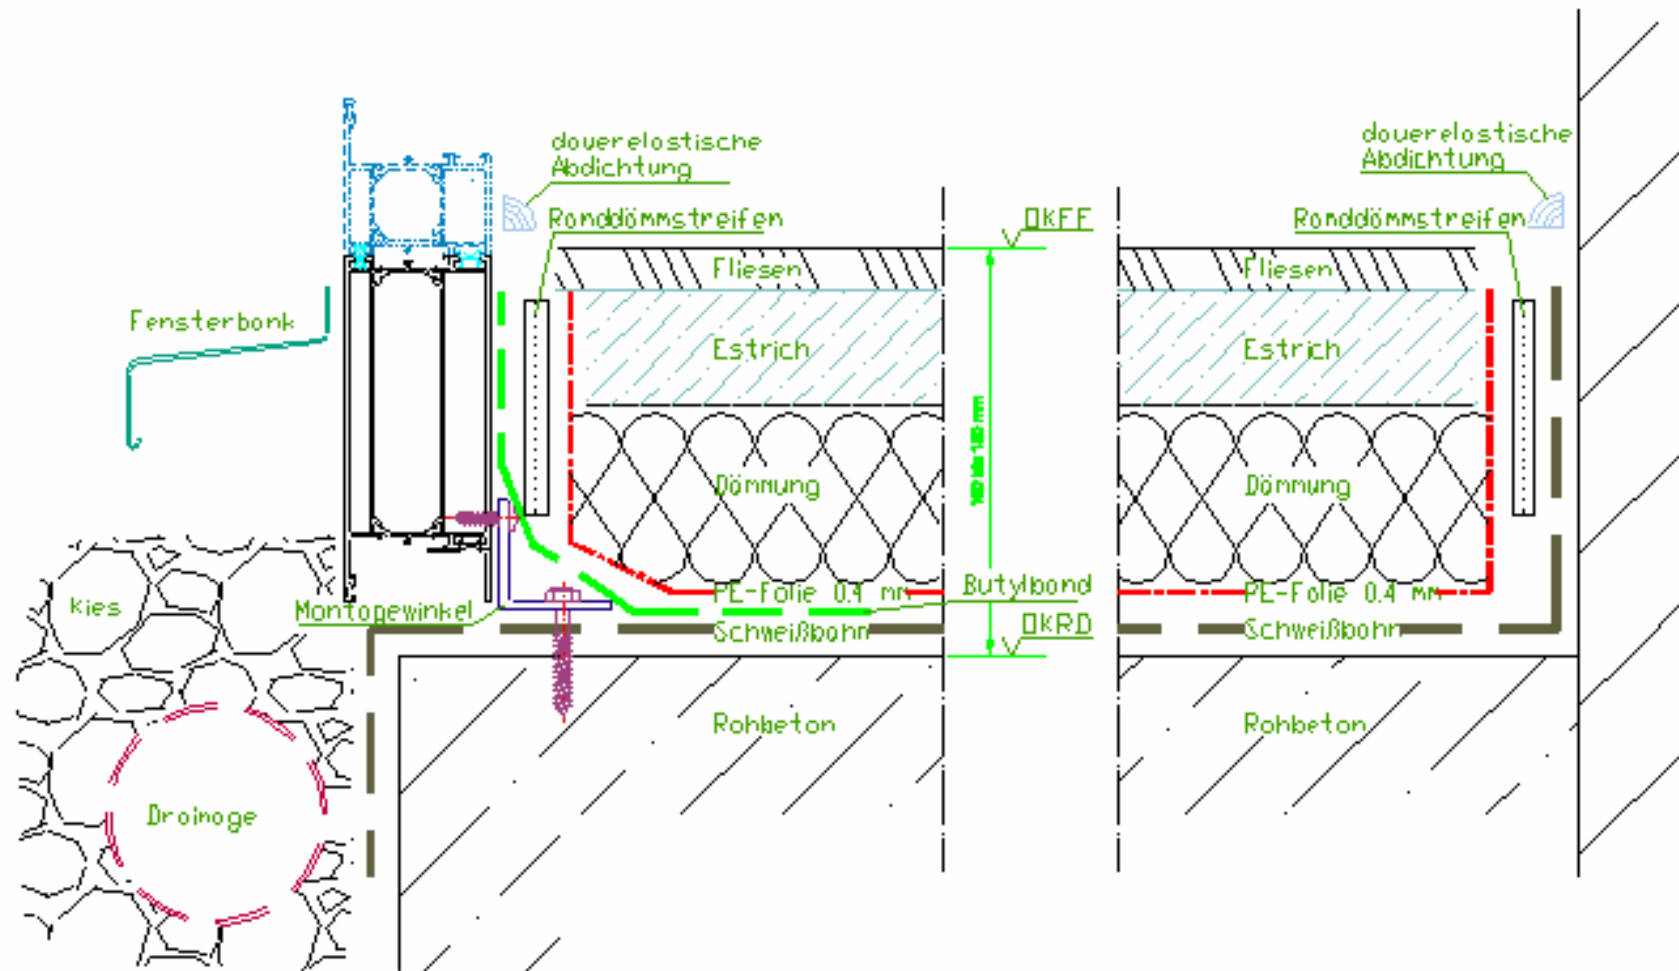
Explosionszeichnung Bodenanschluß, Aluminium-Elemente-Unterbau
